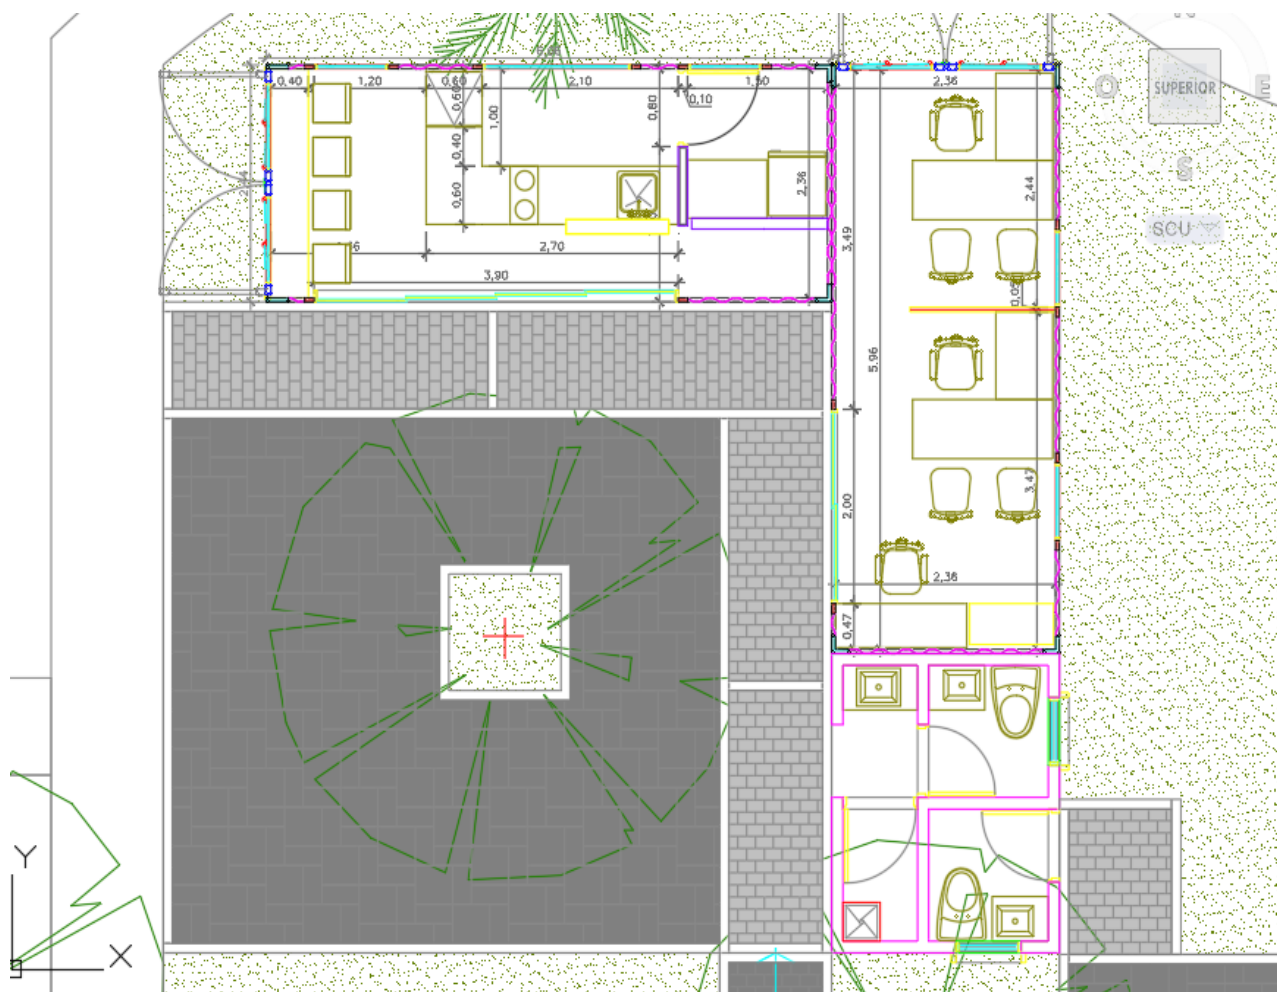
Planimetría Food Park Graficacion Empresa 180°
